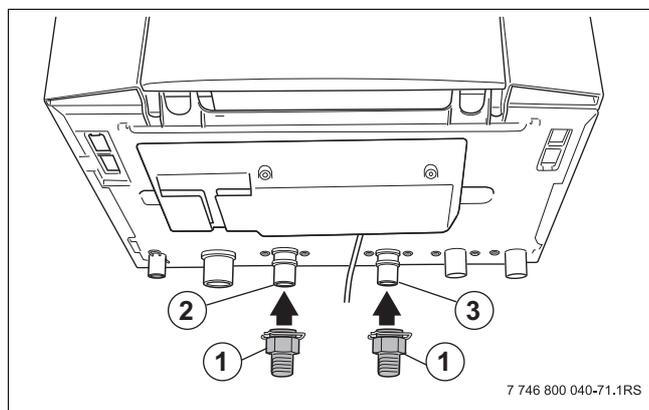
Rohrleitungen für externen Warmwasserspeicher montieren
